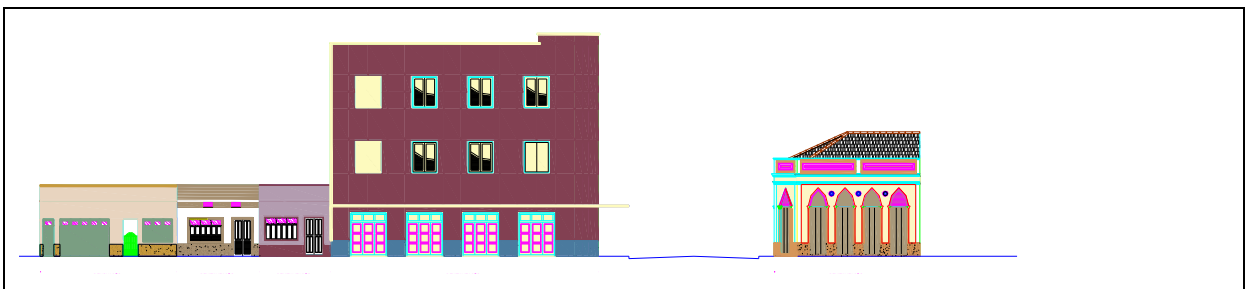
Fachadas Revitalizadas - Quadras 34 e 25 da Rua dos Andradas, com propostas para as fachadas.
